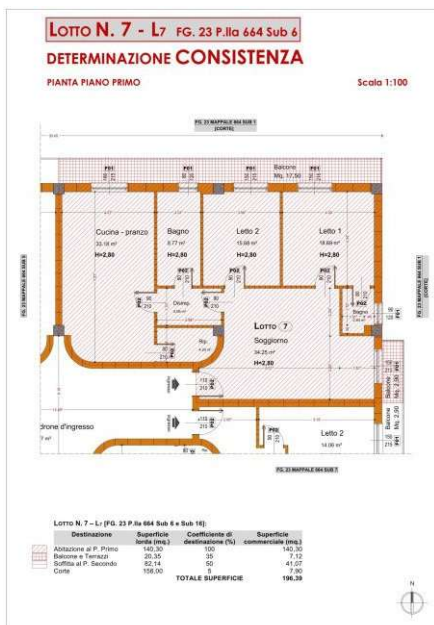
Determinazione consistenza Lotto L7 (ALL. 11).
